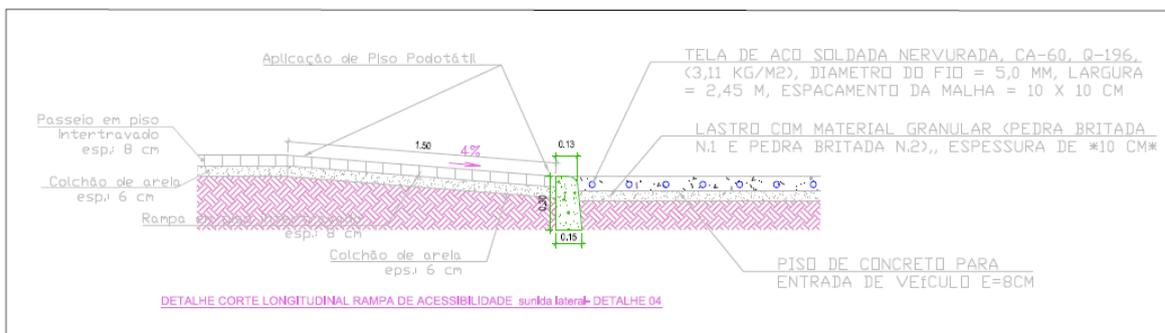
Corte transversal da calçada rebaixada de entrada de veículos pesados (Rua Tegino Vargas)
